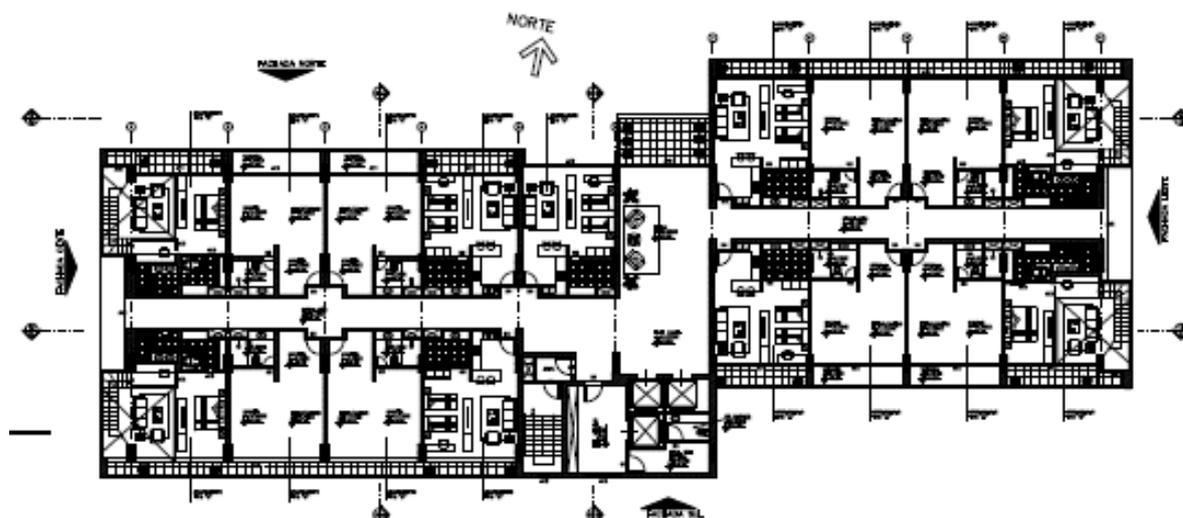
Configuração do Pavimento Tipo. Fonte: Arquivo Pessoal do Autor.
